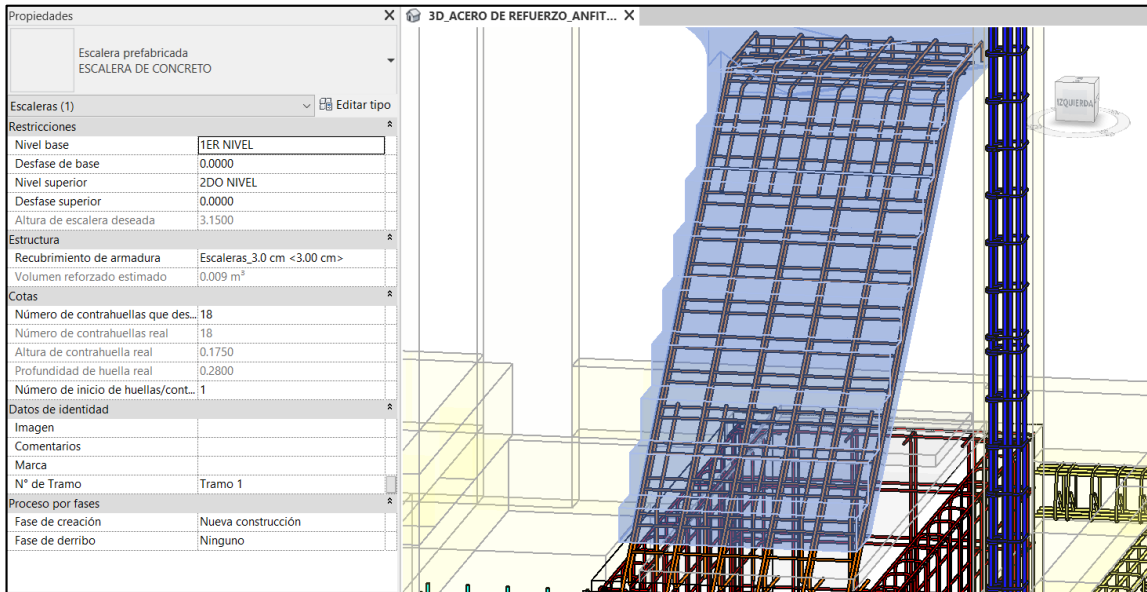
Vista 3D – Acero de Refuerzo en Escaleras en BIM
